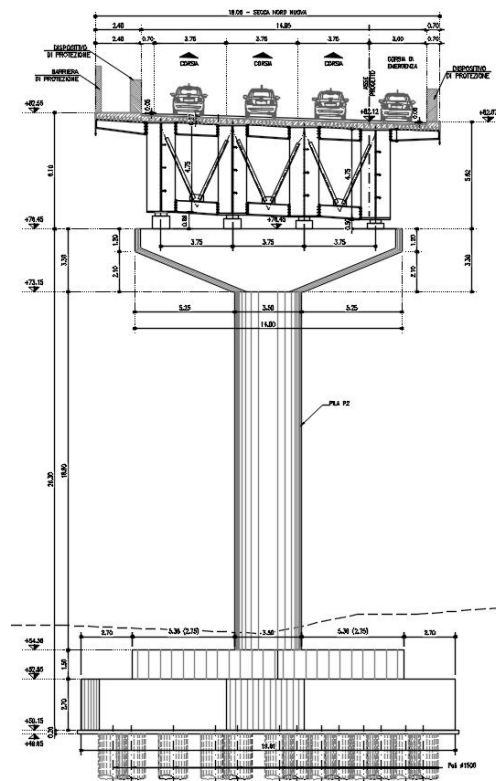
Pila a mensola - Sezione trasversale Pila P2
